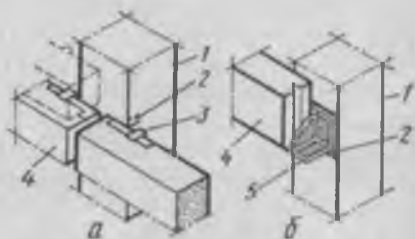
Крепление стеновых панелей к колоннам каркаса:
